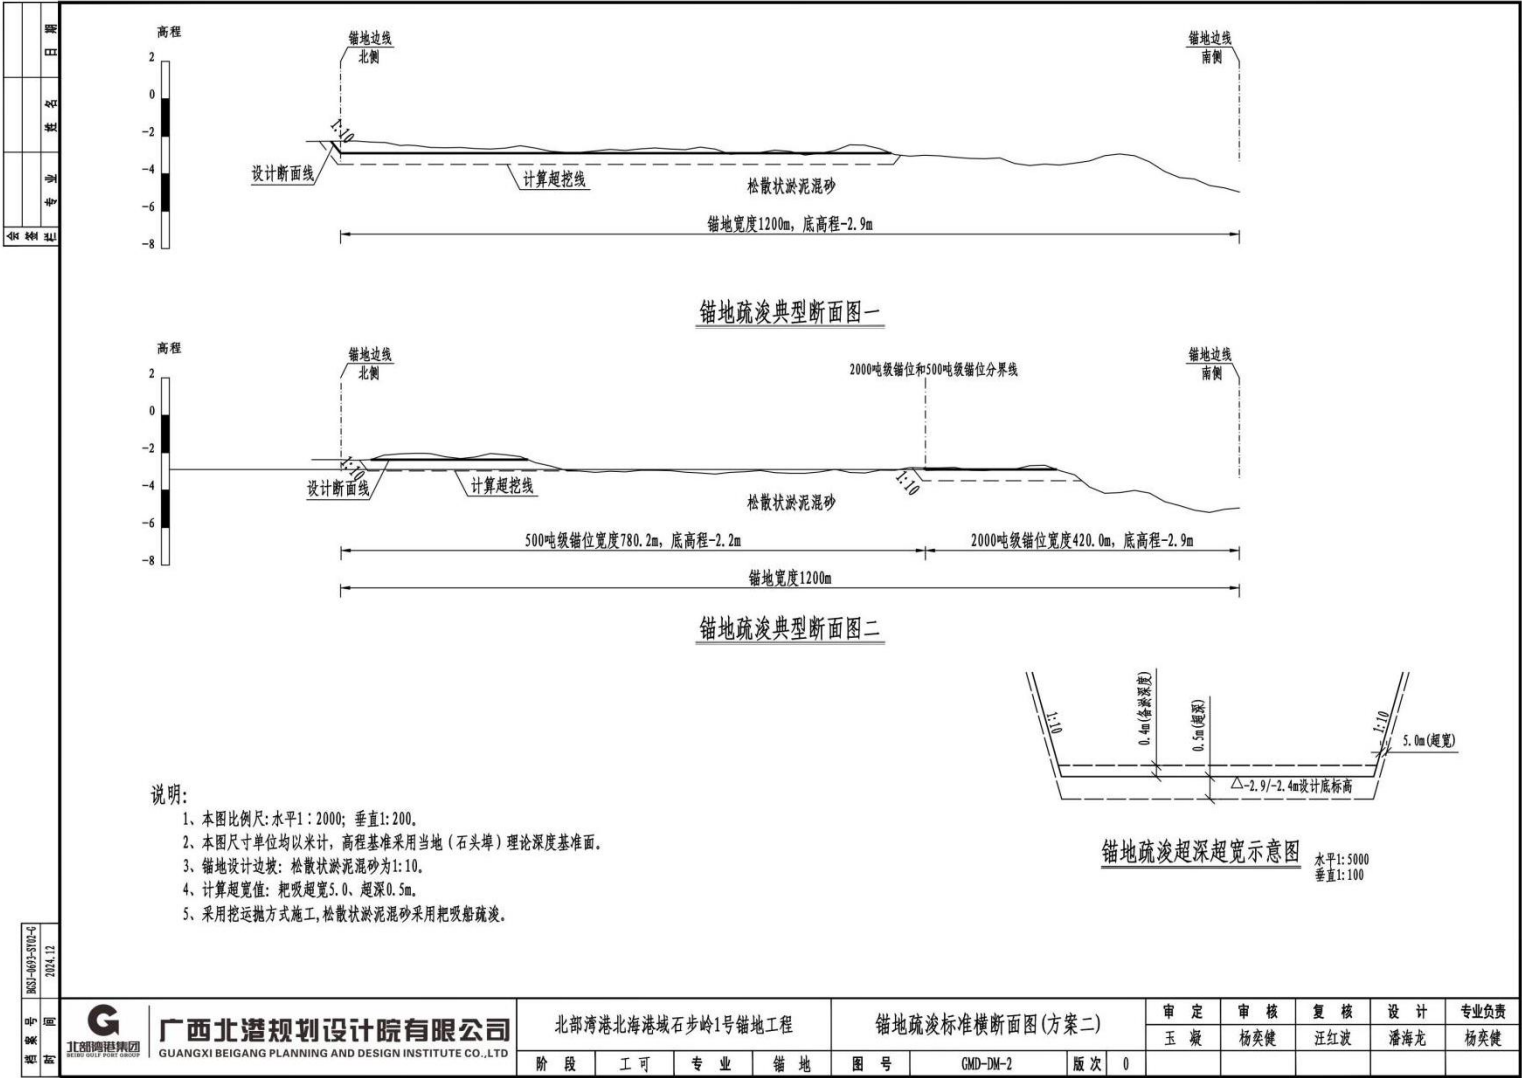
项目锚地疏浚标准横断面示意图-2
